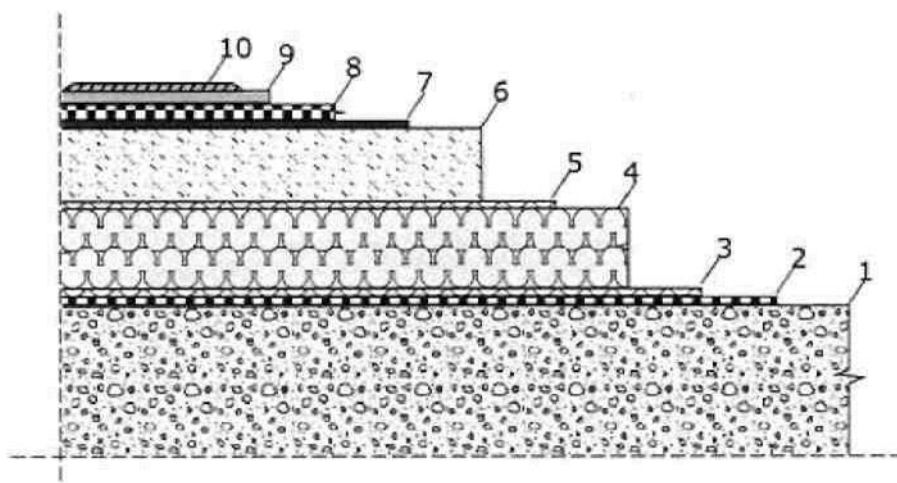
Устройство не эксплуатируемой кровли на бетонном основании
